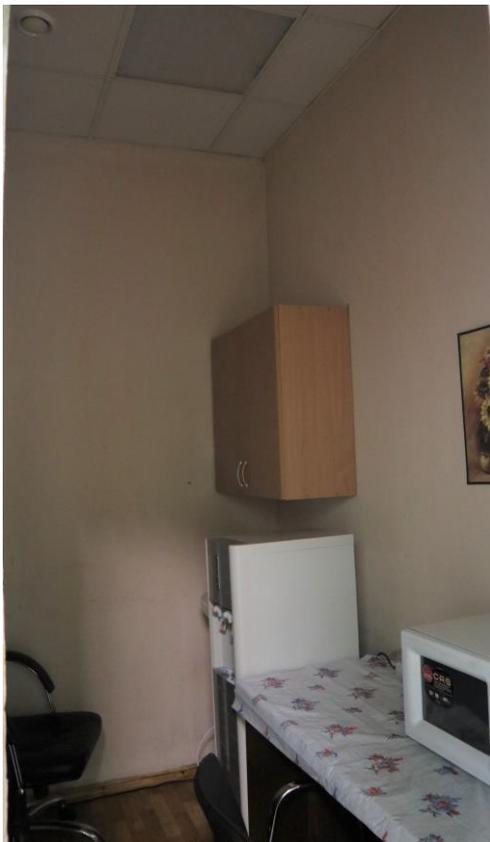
1 этаж, служебное помещение, 18Н (10).
